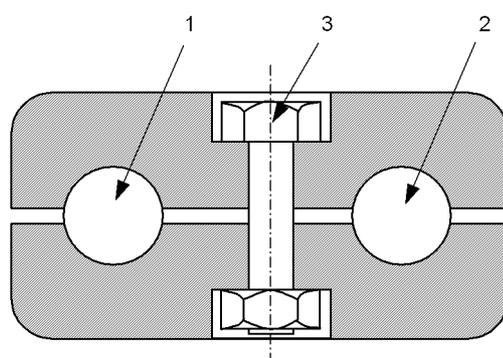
Verbindung eines Rundleiters mit einem Bewehrungsstab
